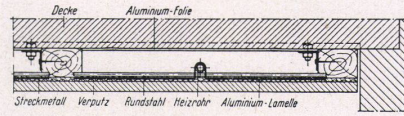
Querschnitt durch eine Deckenausführung mit Heizrohr und Lamelle nach der Stramax-Bauart.
